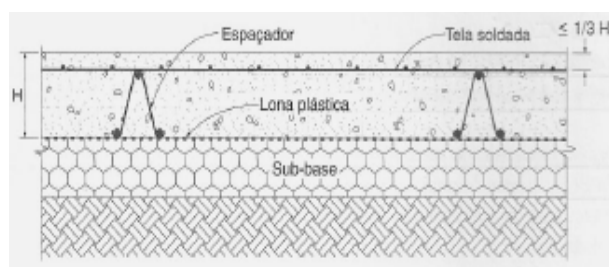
Pavimento de betão simples com armadura distribuída, [22].
